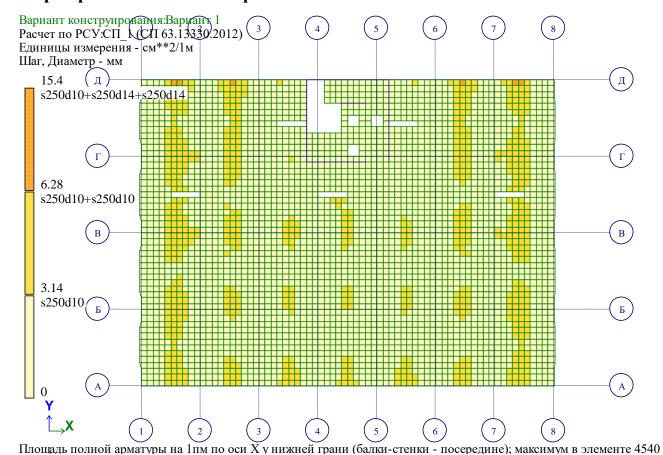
Расчетное армирование плиты покрытия по оси X у нижней грани.
